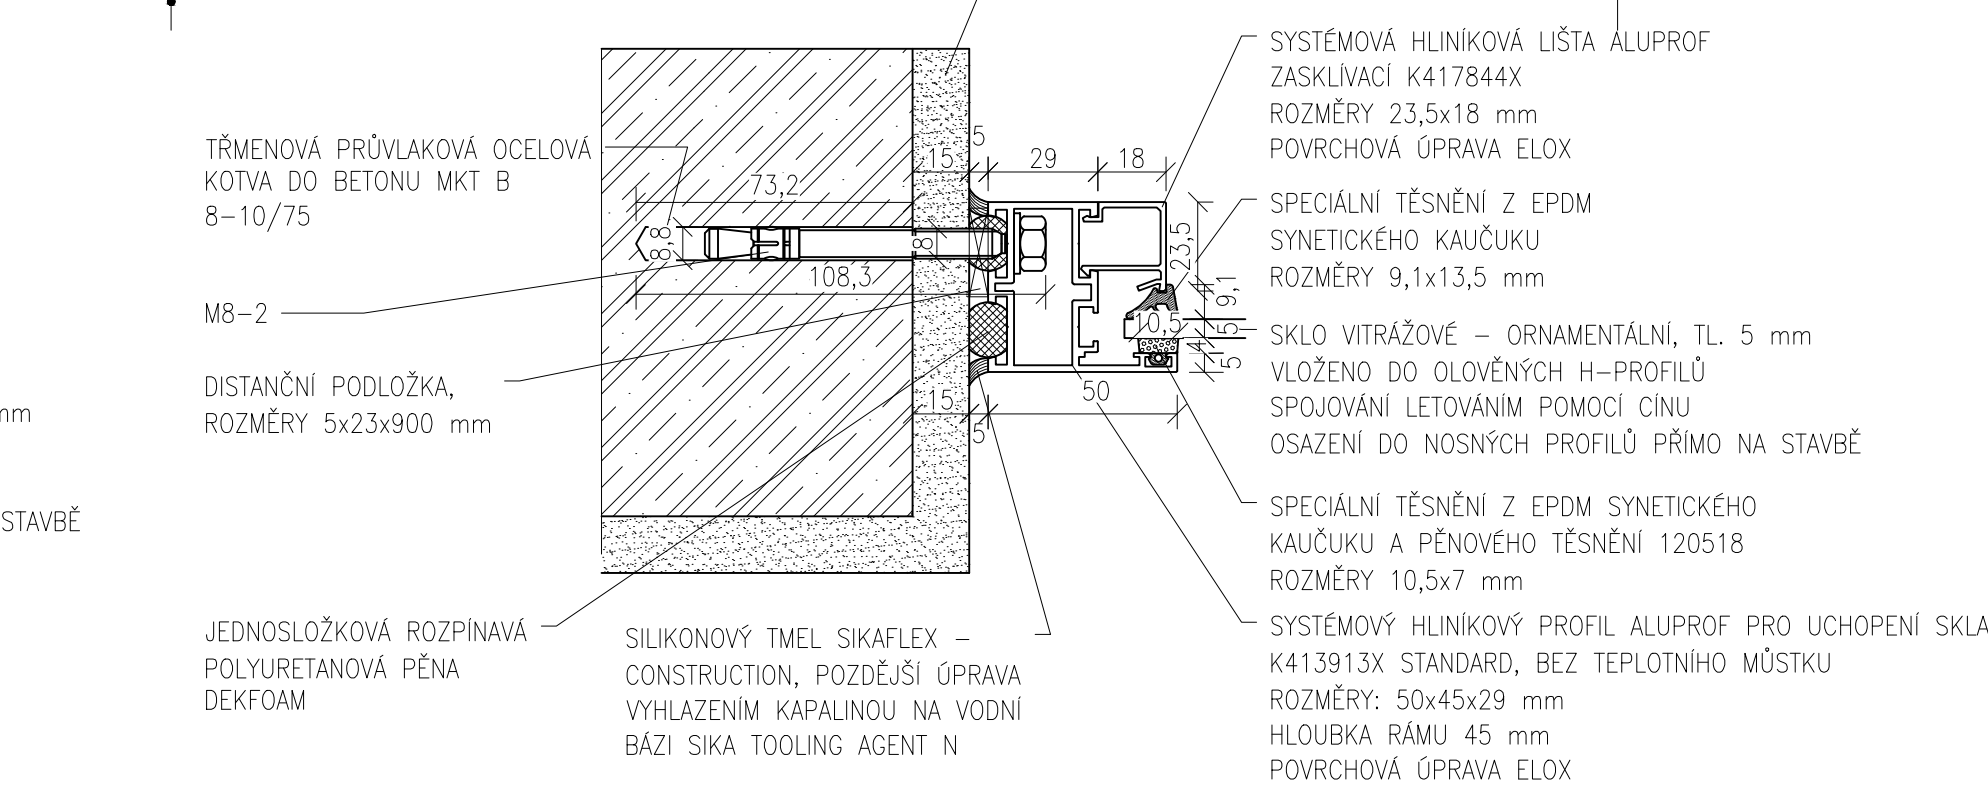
PROFIL PRO DVĚ SKLA, PŮDORYSNÝ ŘEZ, MĚŘITKO 1:2
